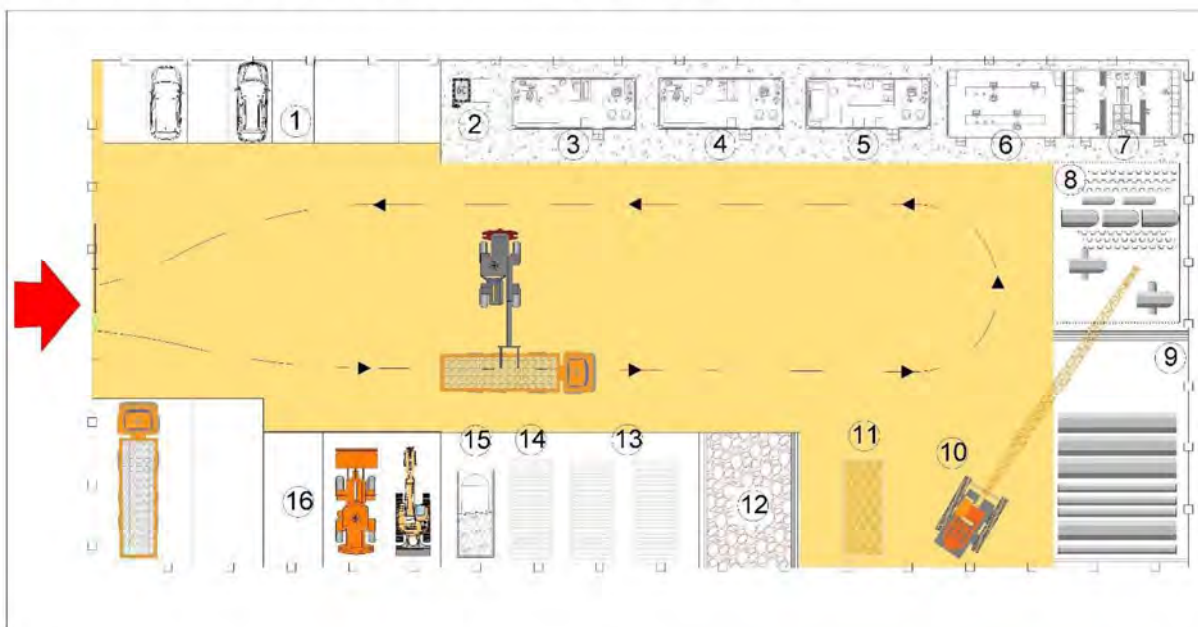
Layout cantiere Area logistica Di Supporto tipologica.
